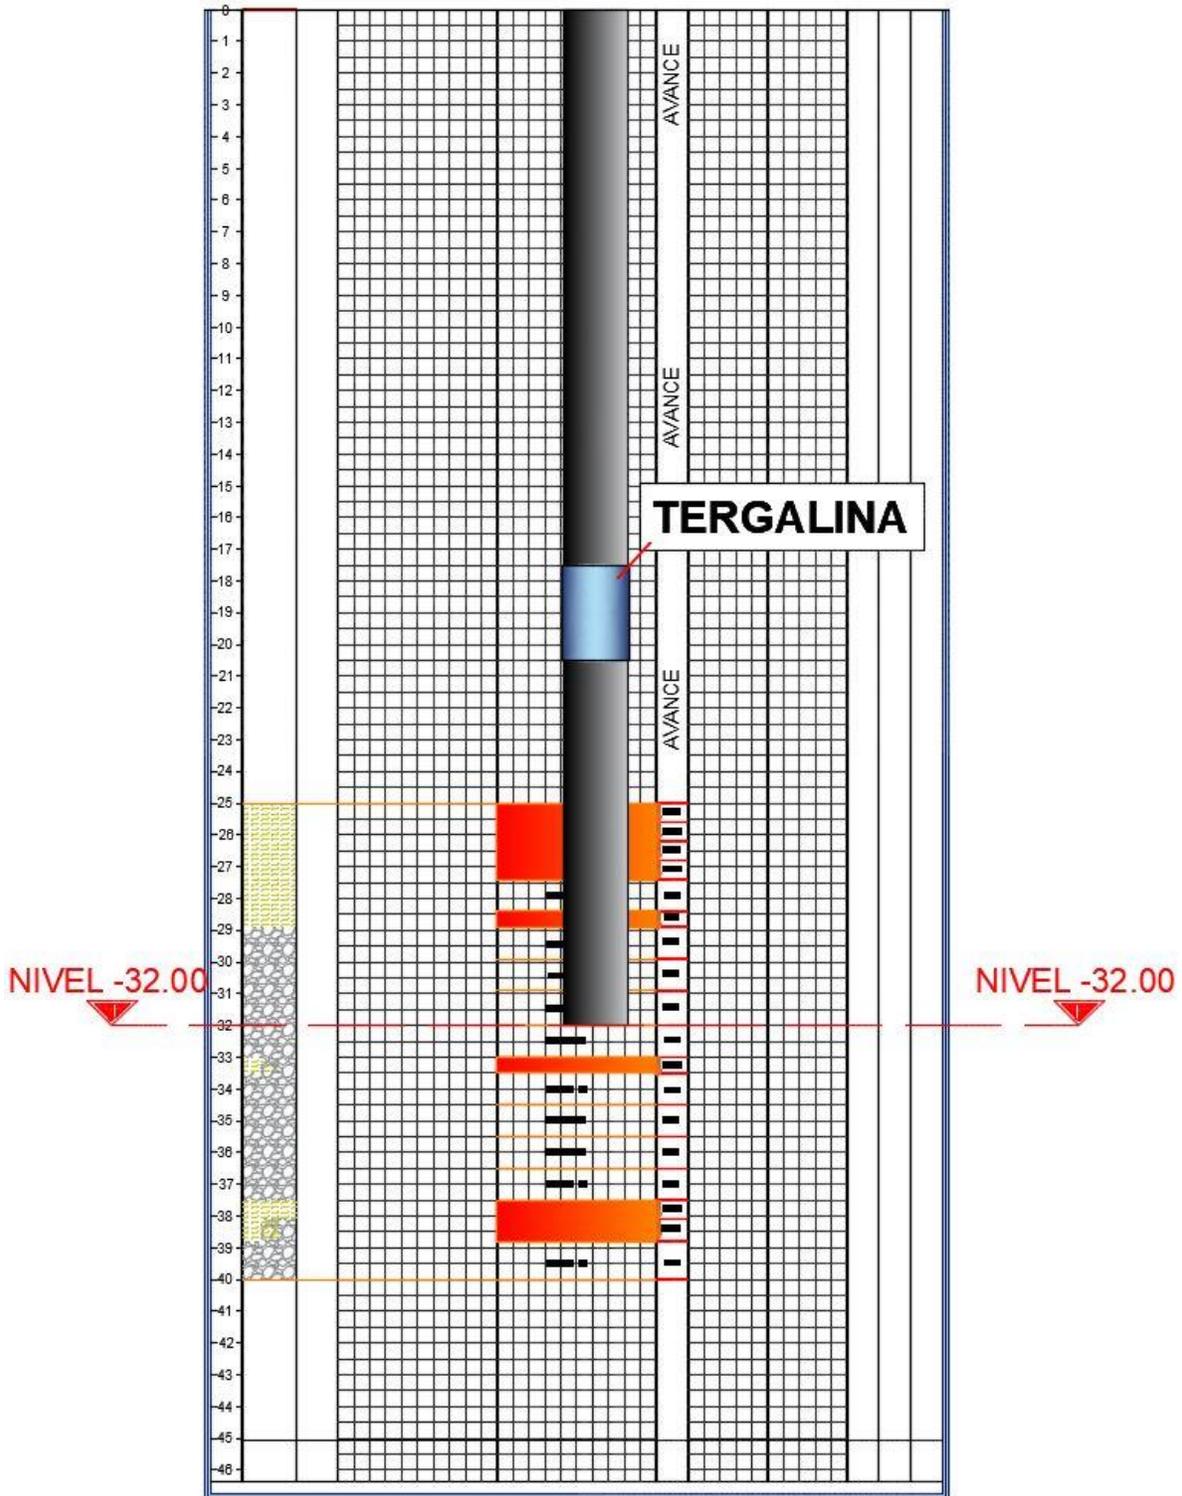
PILA 20 (SM-20 EJE G6).
